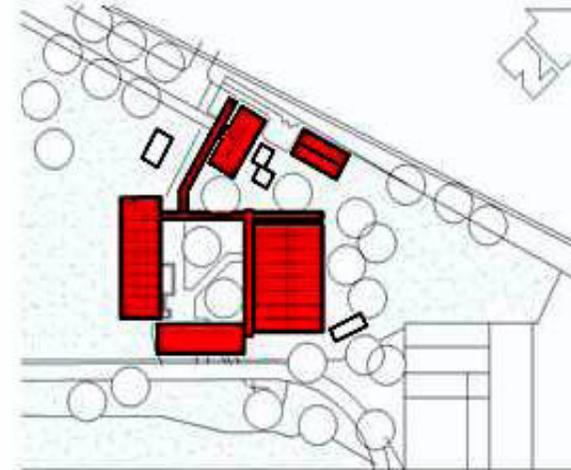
Facultad de Arquitectura. Planta de conjunto. 1967
